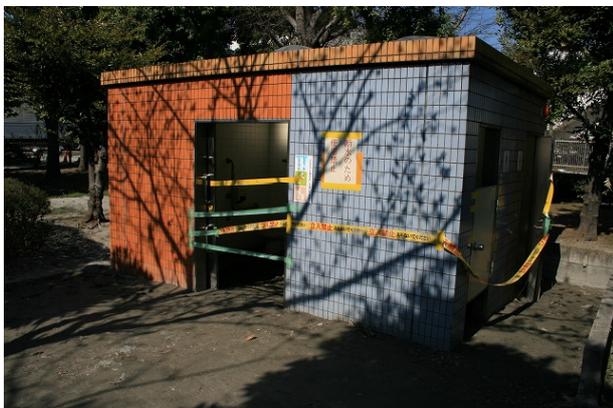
噴砂によるトイレの埋没（浦安市）
